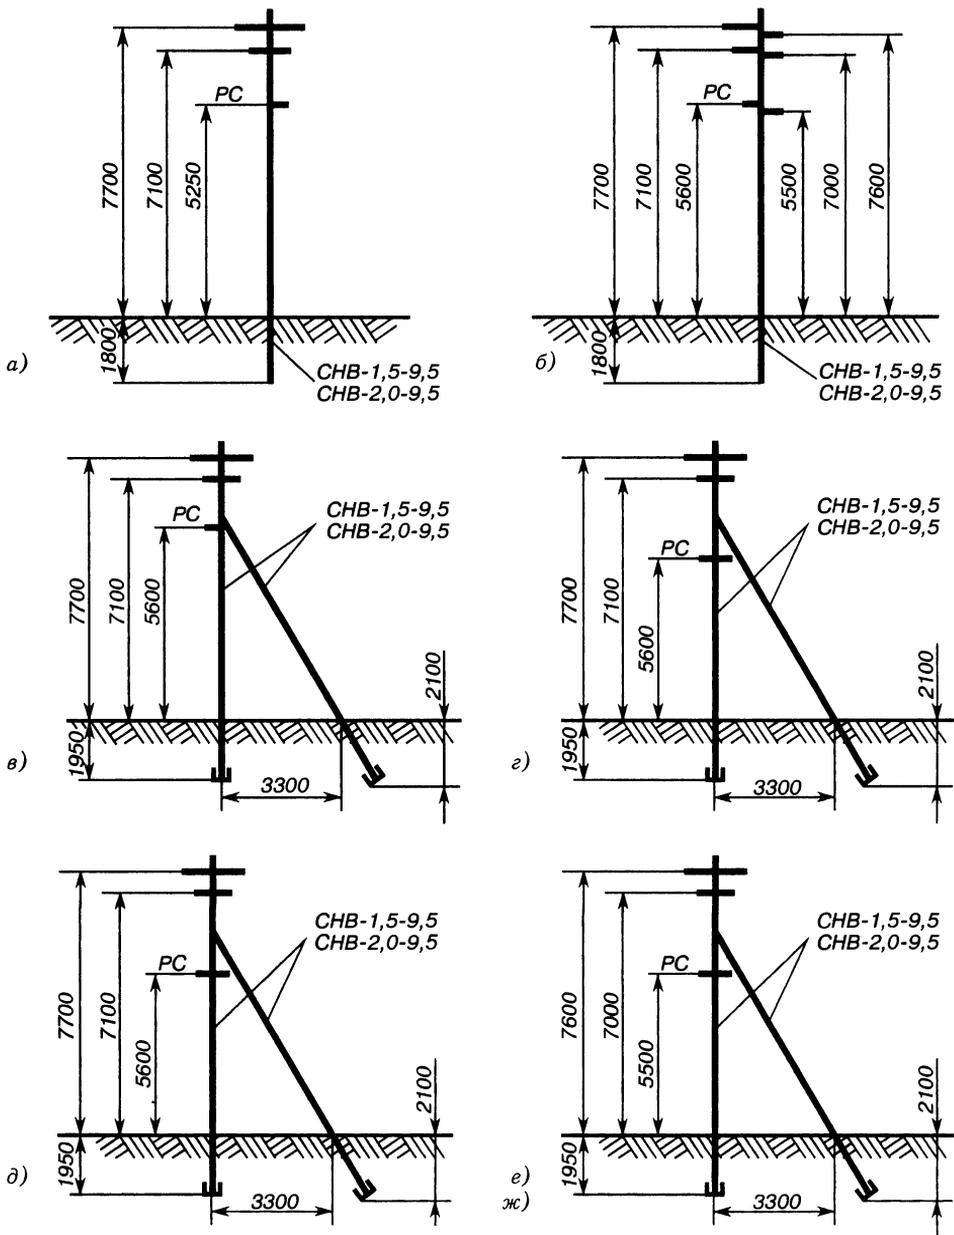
Схемы железобетонных опор ВЛ 0,4 кВ по типовому проекту 3.407–122.
